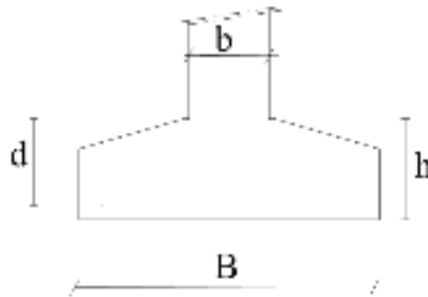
Dimensionnement d'une semelle isolée dans le sens y-y.
